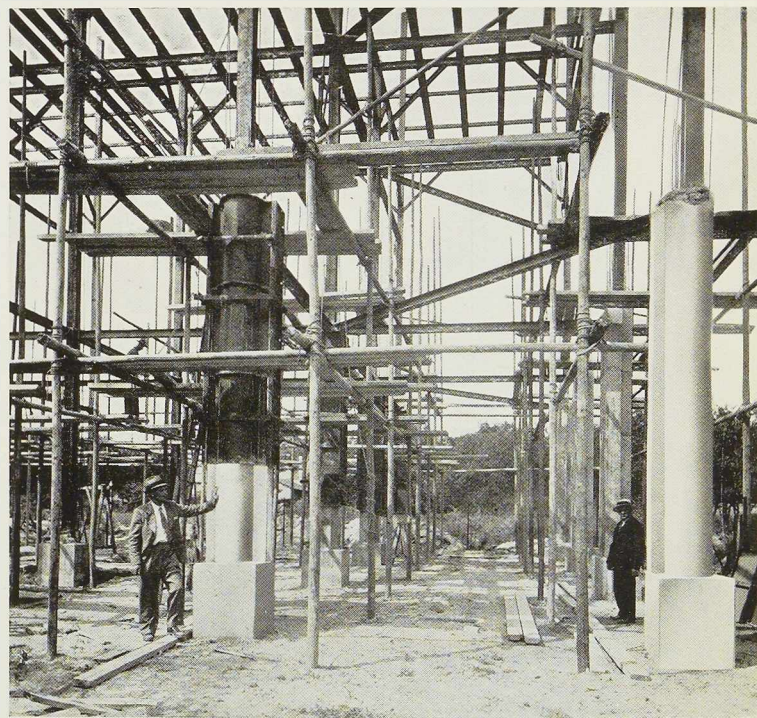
L'ossature rigide en poutrelles H du nouveau réservoir.
